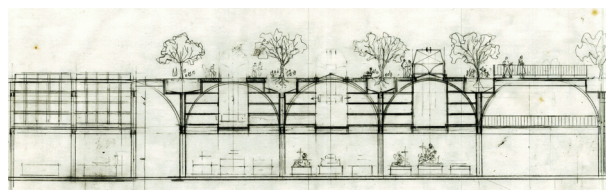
| "Corte cubista" do cemitério vertical do Campo Santo, projeto de Rebouças (1993-94)
